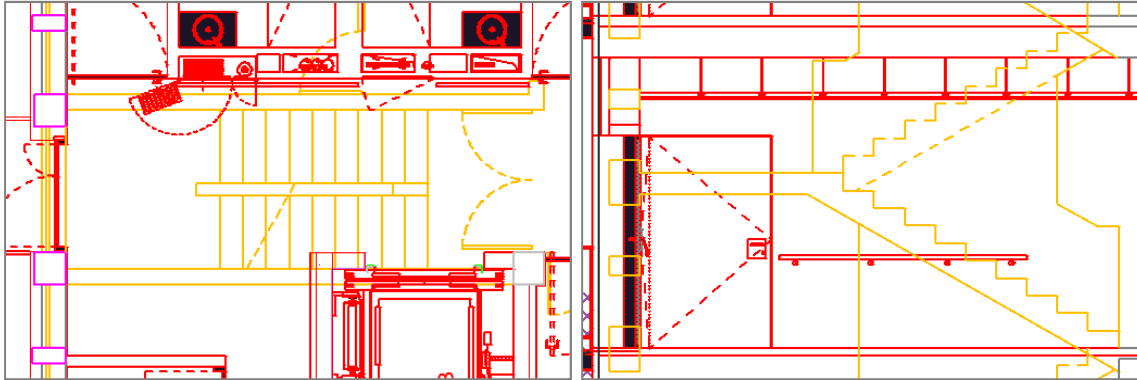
Núcleo de escadas a demolir (planta e corte) [10]
